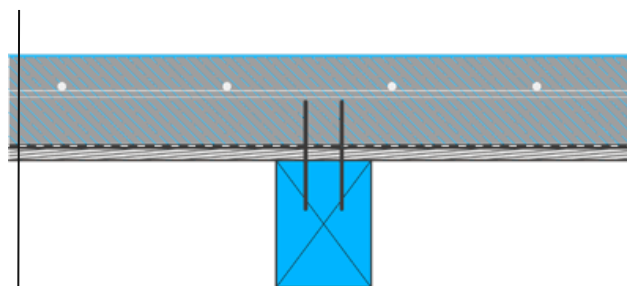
Querschnitt Holz-Beton-Verbunddecke³⁰
